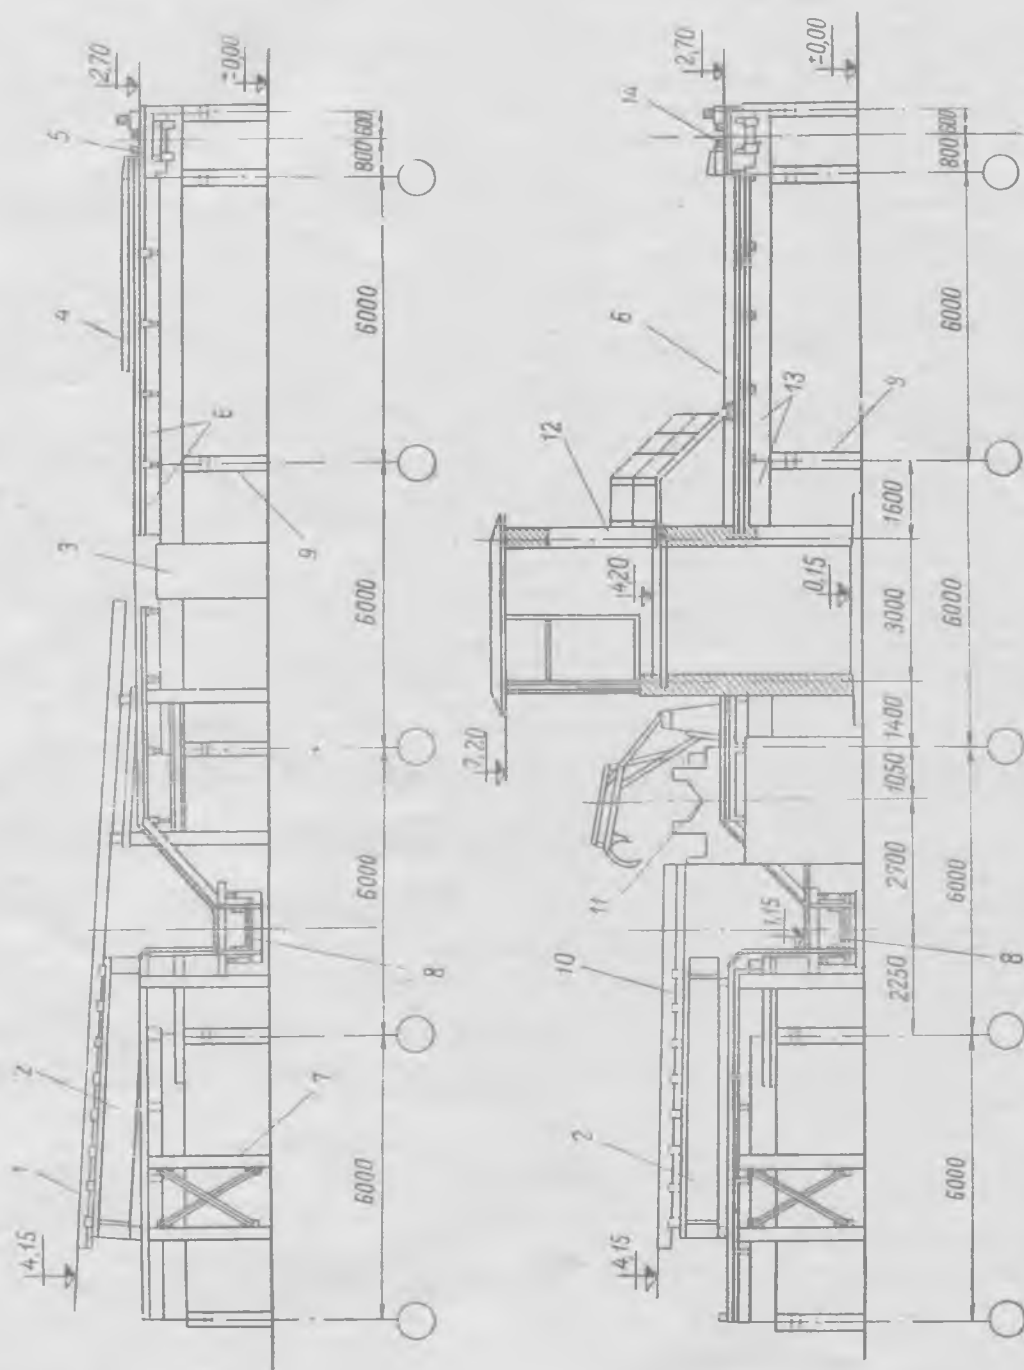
Железобетонная эстакада для нижнего склада (вариант III): вверху — разрез по первой ветви РД-2; внизу — разрез по зданию операторской;
